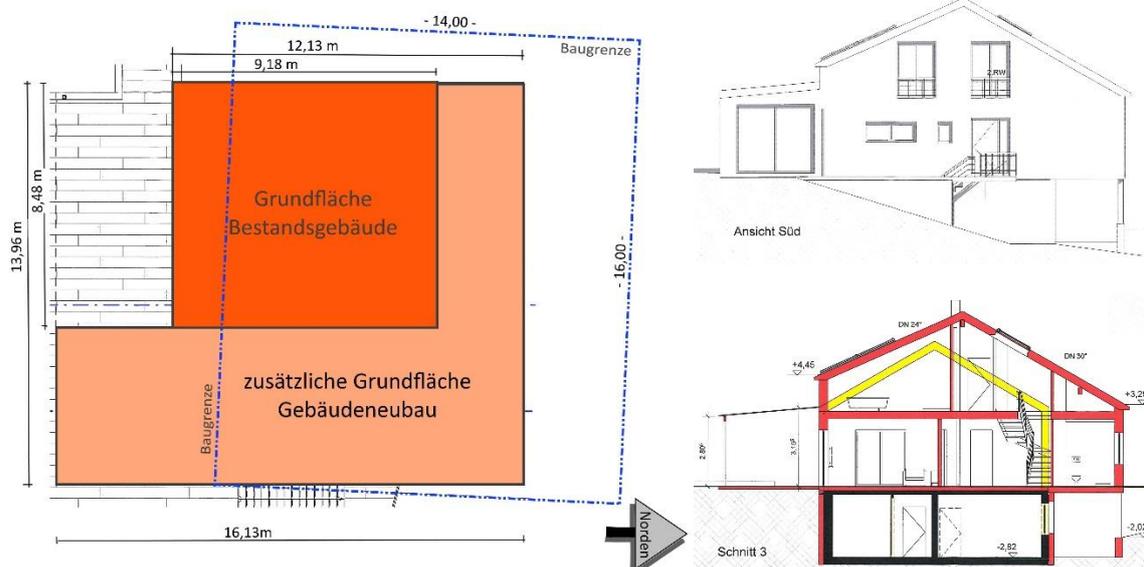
Lageplan (von Stadtverwaltung für Beschlussvorlage überarbeitet), Ansicht und Gebäudeschnitt
